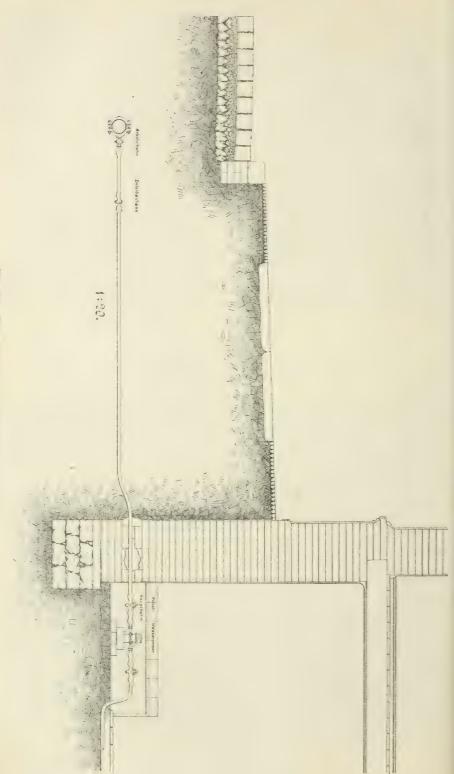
Haus-Zuleitung mit Wassermesser in Berlin.
